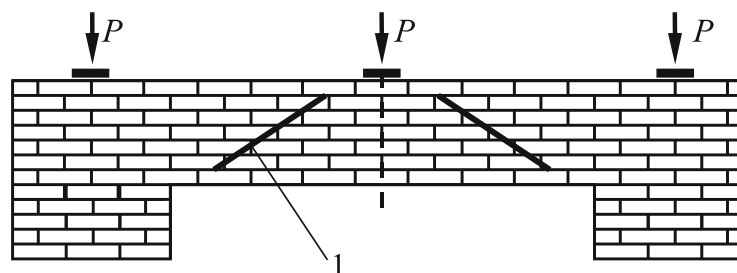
Схема нагружения каменной перемычки поперечными силами P от стропильных балок и механизм разрушения в результате образования косых трещин 1
